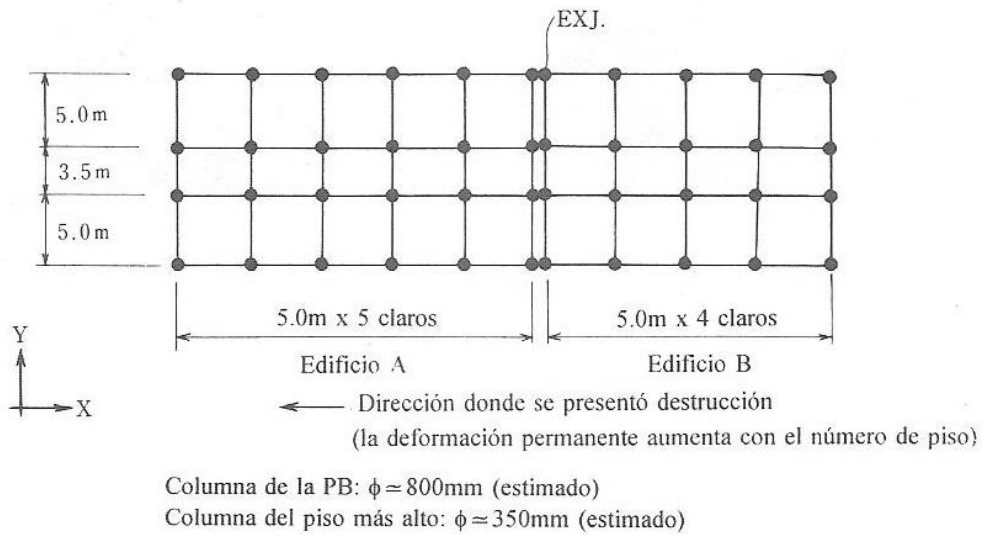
Planta tipo del edificio 237 (Masaki et al., 1996)
